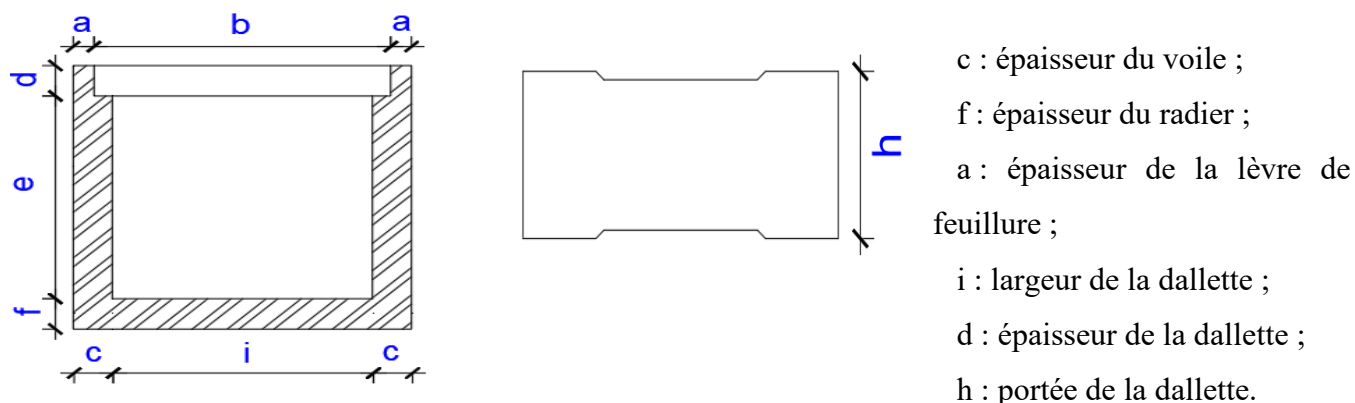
Schéma du principe d'un caniveau de la dalle
